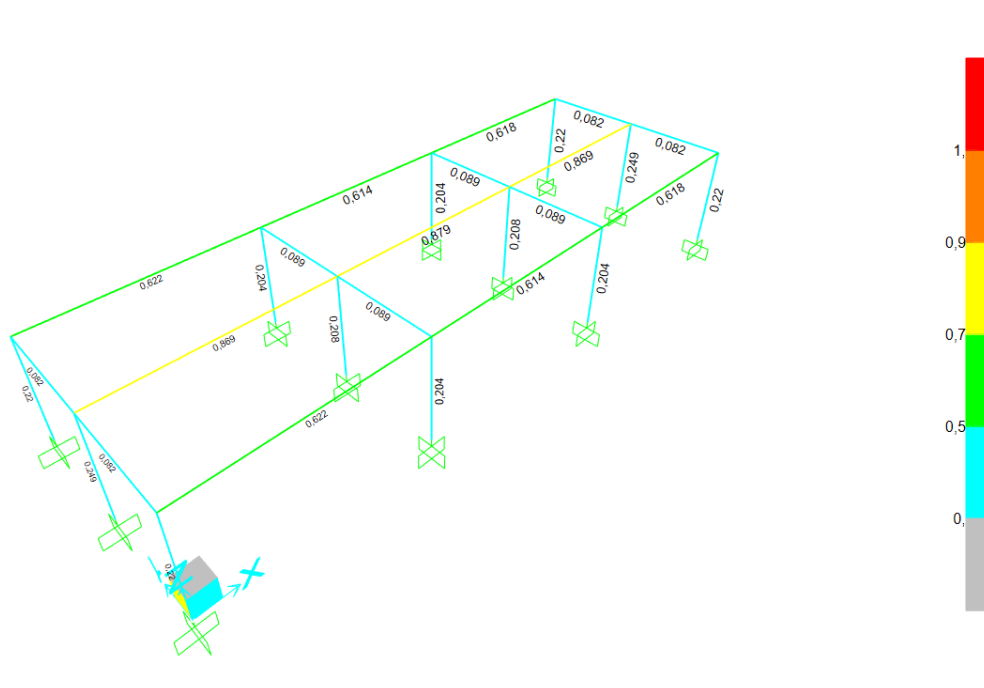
Porcentaje de capacidad de carga de elementos en vivienda de pórticos de acero.
